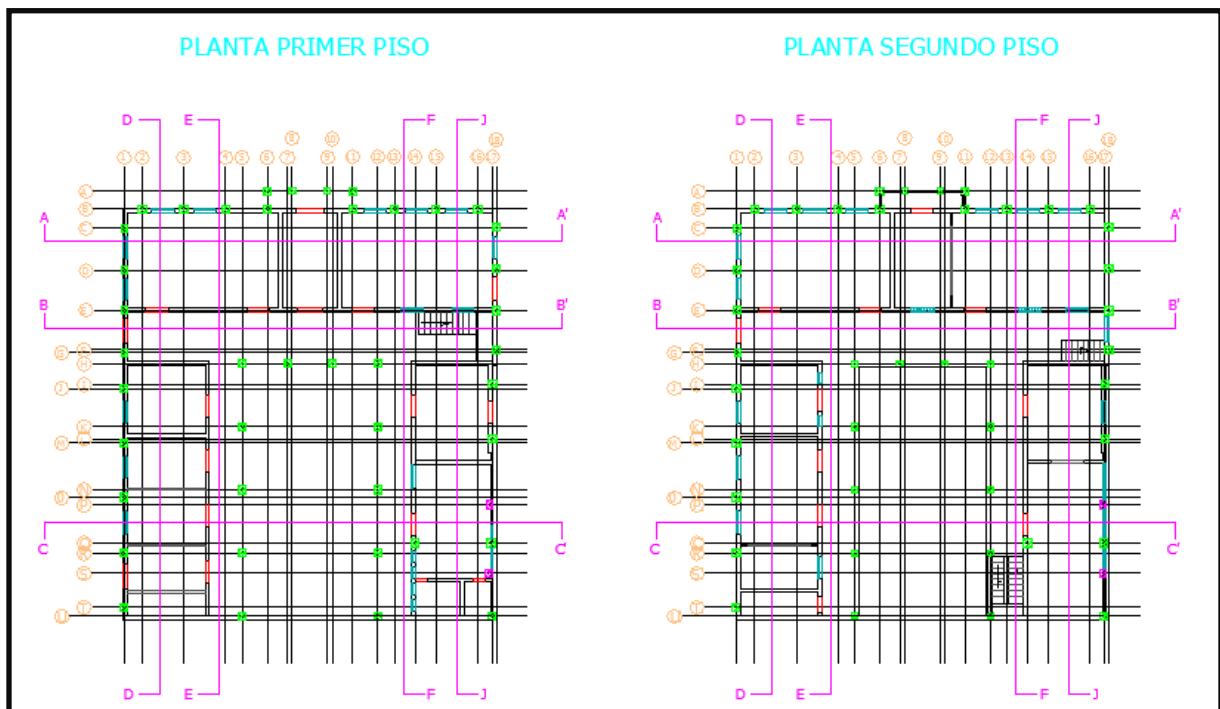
Planos de las plantas del Colegio Inmaculada Concepción (Autor).
